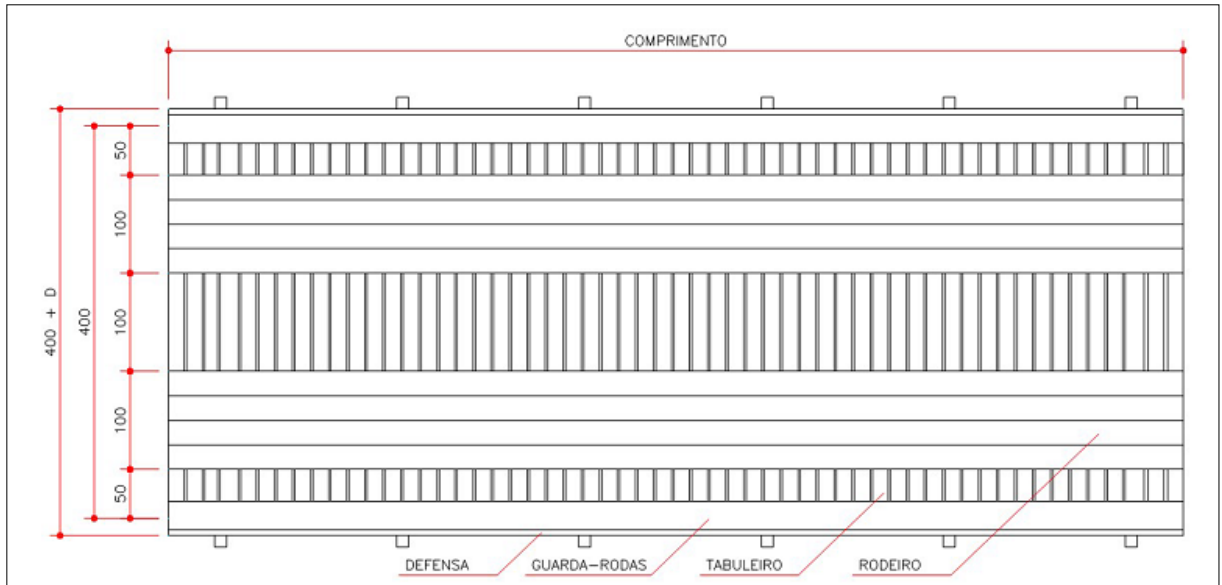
Ponte em Vigas Roliças de Madeira Tratada: Vista Superior da Ponte.
